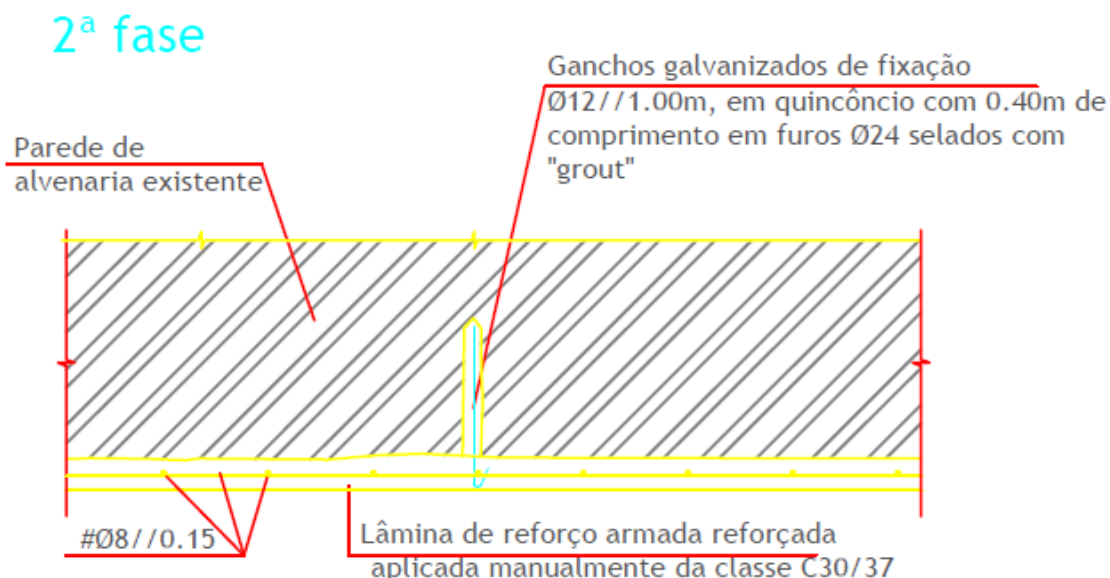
Segunda fase descrita em projeto sobre a aplicação de lâminas de betão sobre paredes de alvenaria existentes
